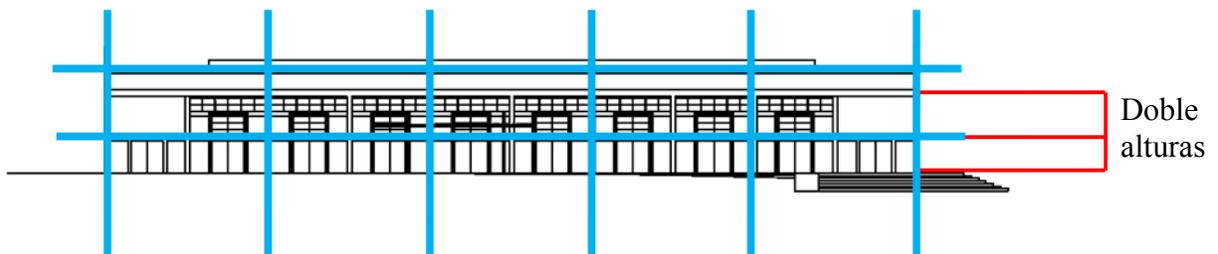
Fachada Norte calle 30. Fuente: Elaboración propia, (2019).
